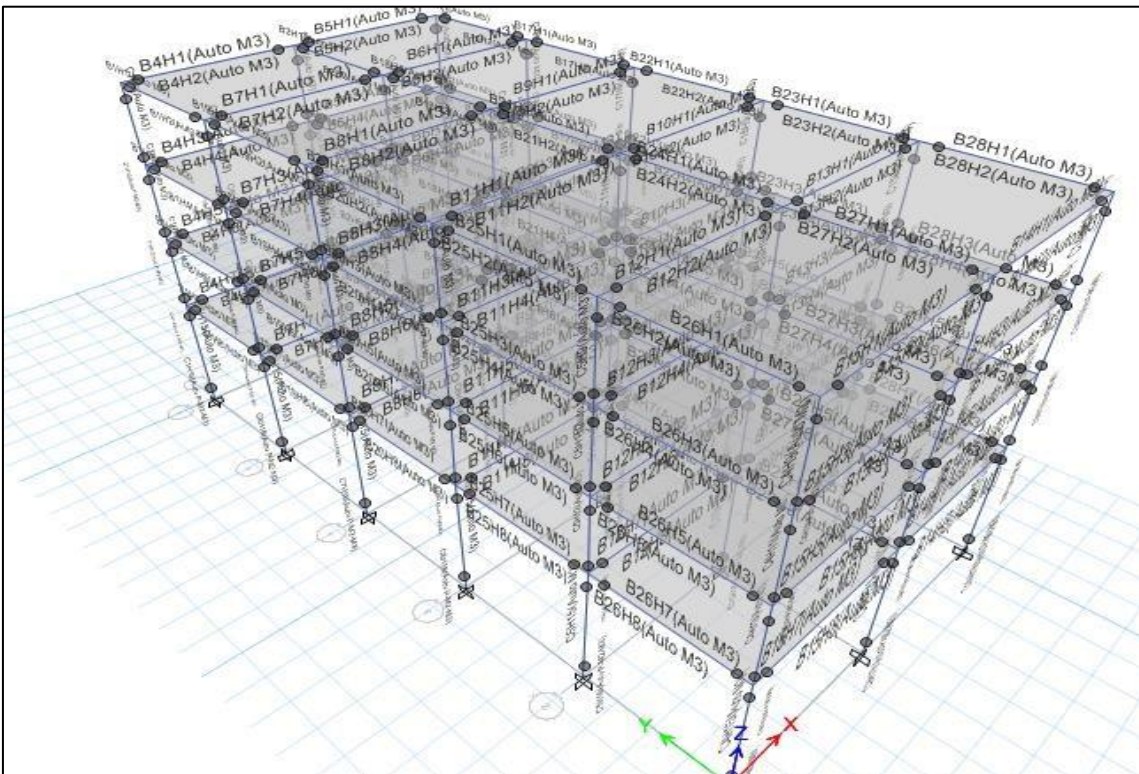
Edificio de pórticos con rotulas plásticas en columnas y vigas.
